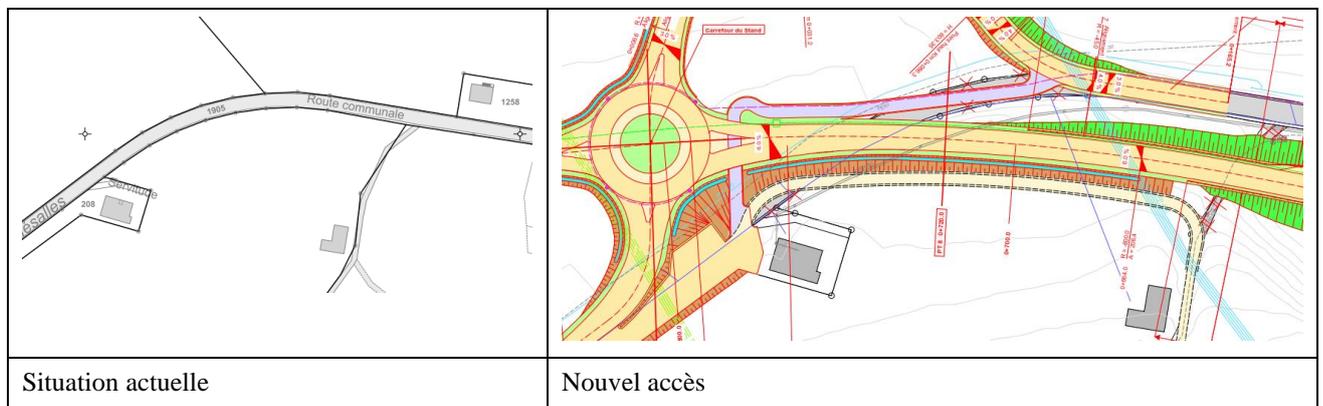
Adaptation du raccord de la route secondaire à la route cantonale
